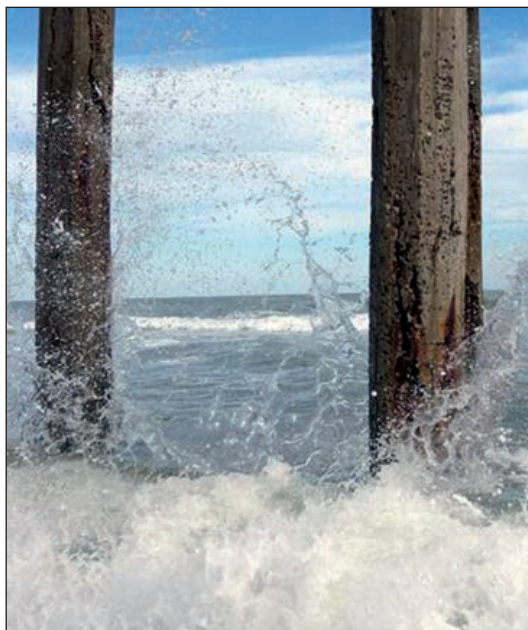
DETALLE DEL EFECTO DE LAS OLAS EN FUSTES DE UNA INSTALACIÓN PORTUARIA.
